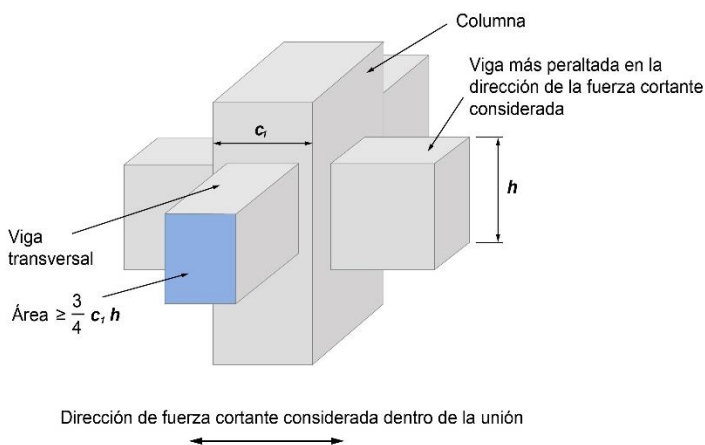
Sección mínima de una viga transversal para propósitos de confinamiento de la unión viga-columna (adaptada de ACI CODE-318-19)
